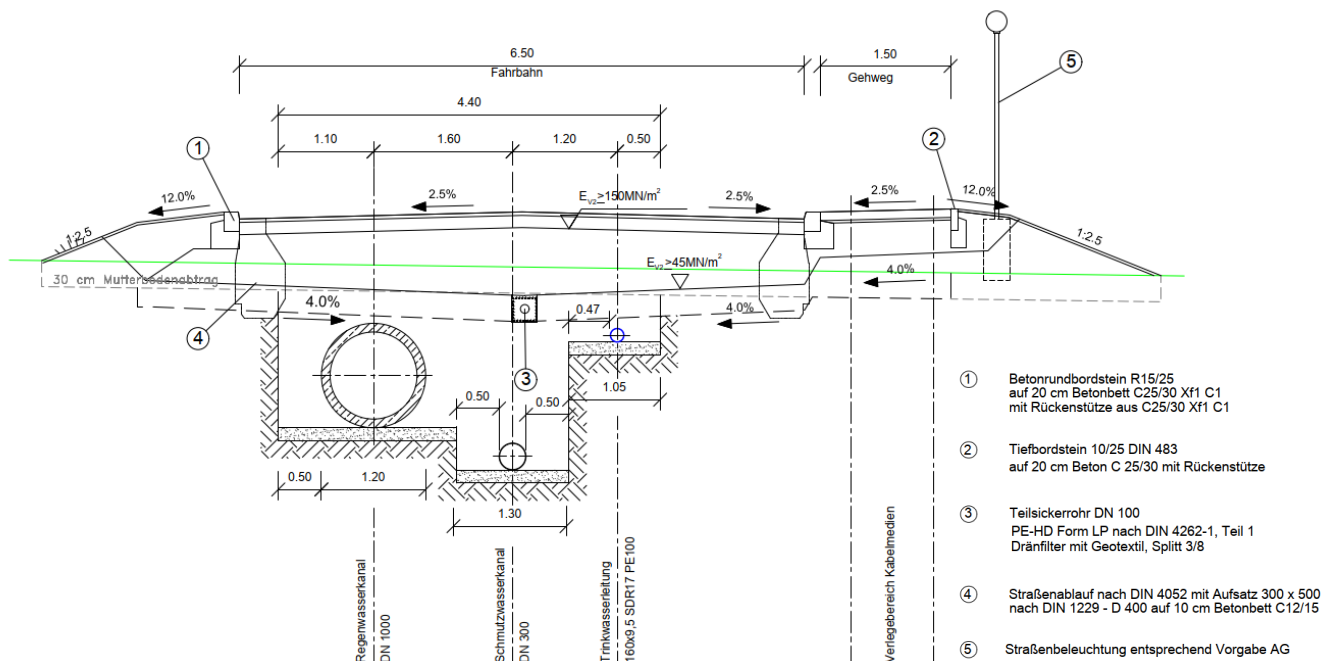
Regelquerschnitt Erschließungsstraße (Ingenieurbüro Hauswald GmbH, 04/2019)
